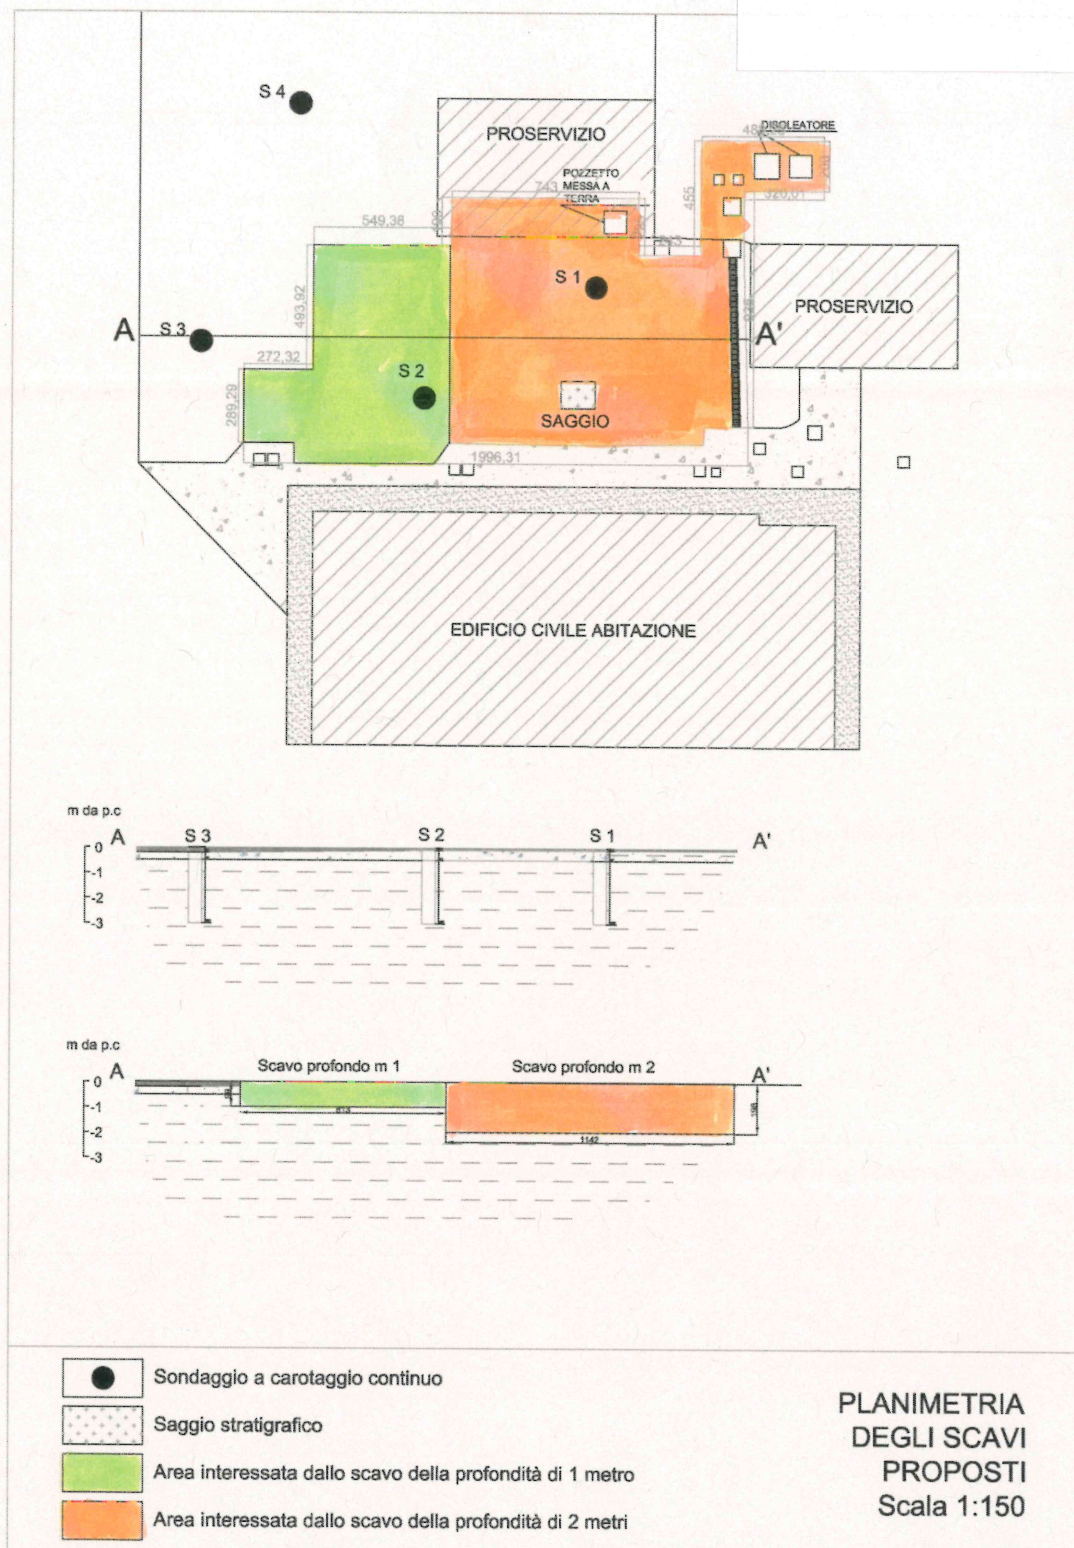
Planimetria del sito e sezione A-A' con estensione lungo verticale degli scavi proposti
